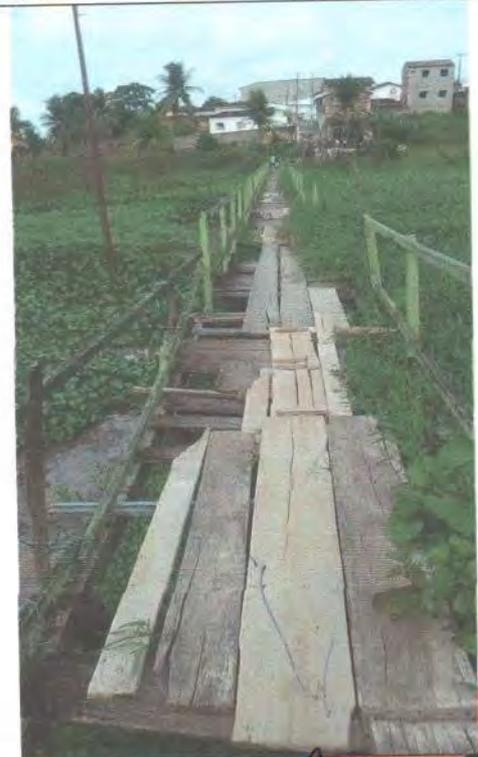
Vista do material construtivo na via de pedestre da comunidade local
